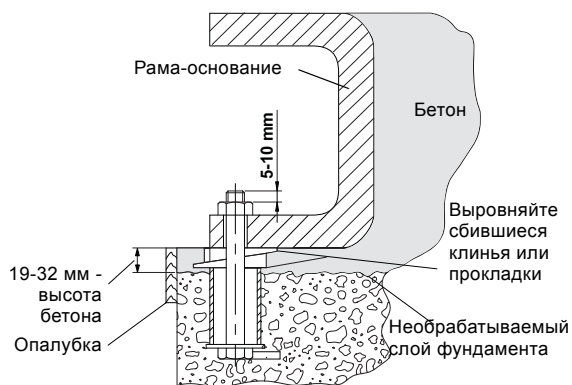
Вид в разрезе фундамента с фундаментным болтом, бетонной заливкой и рамой-основанием
